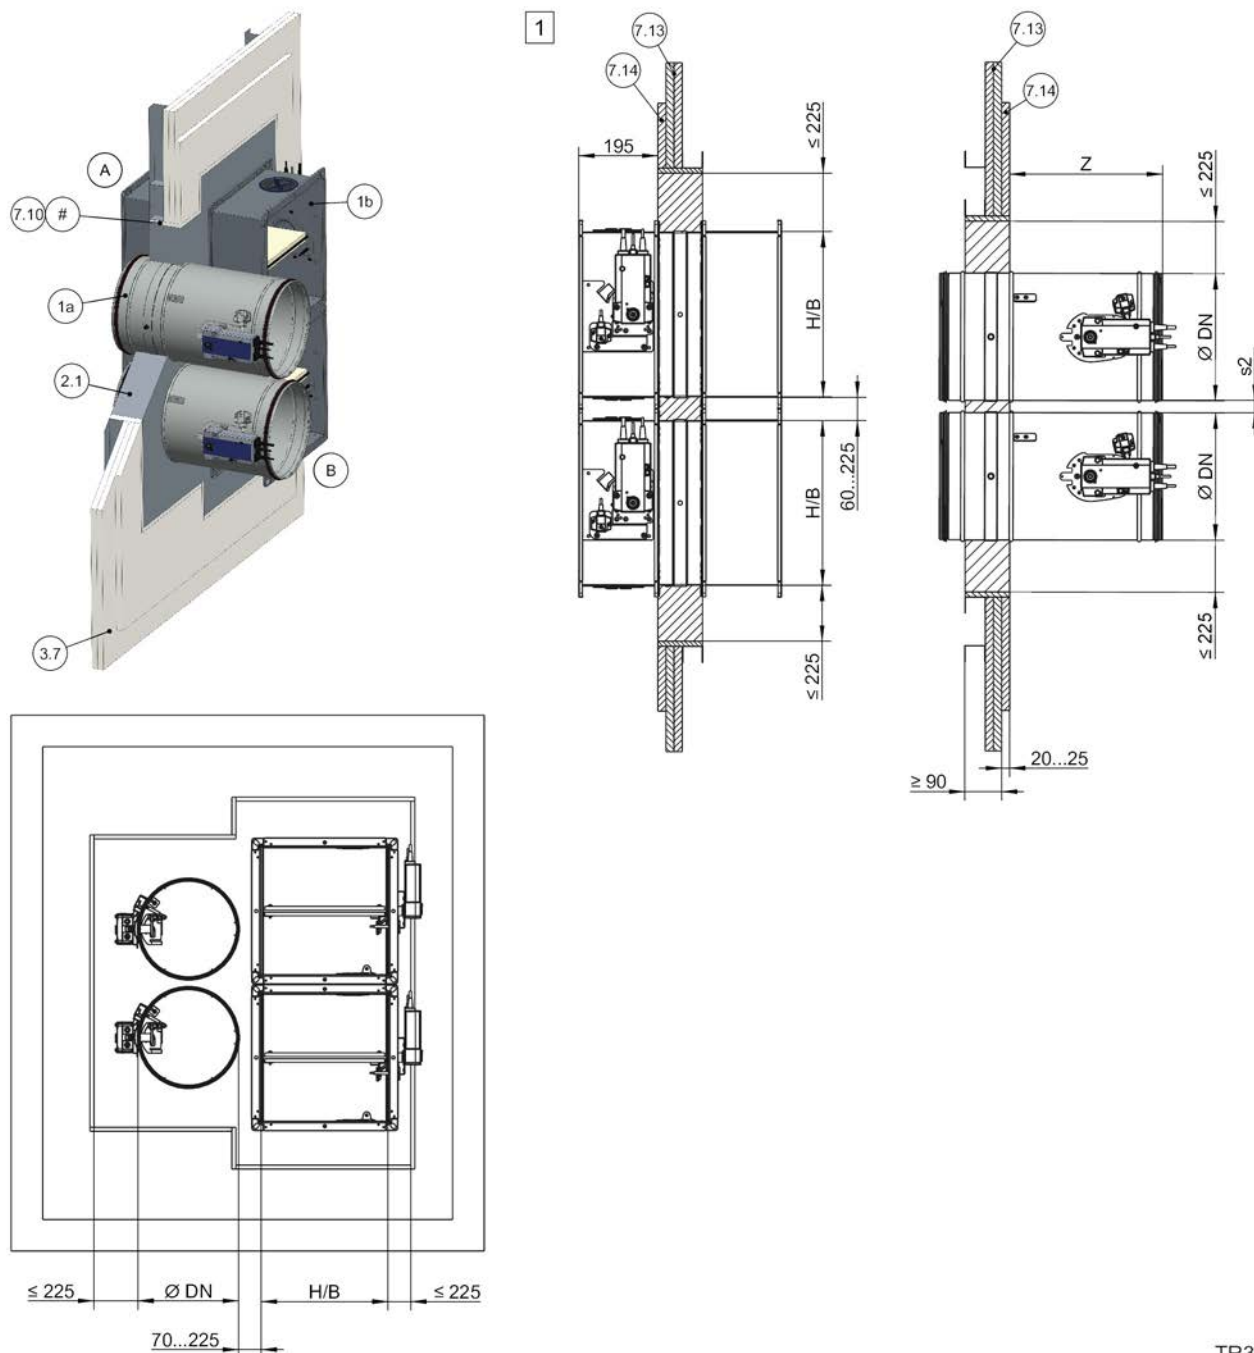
Montagem molhada numa parede de caixa com estrutura de apoio de metal
